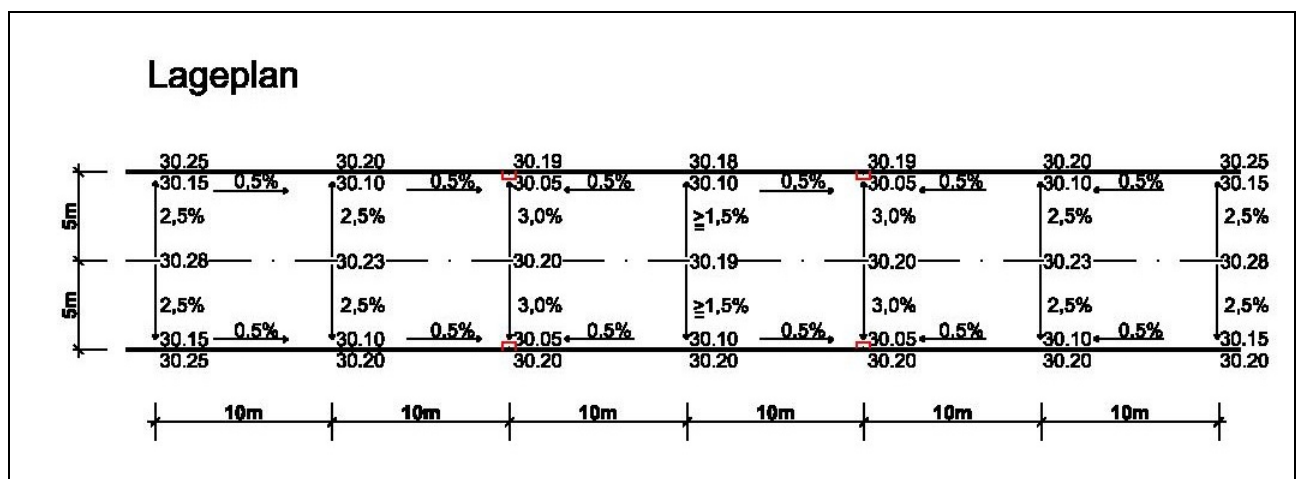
Beispiel eines Sägeschnittes im Lage- und Deckenhöhenplan
